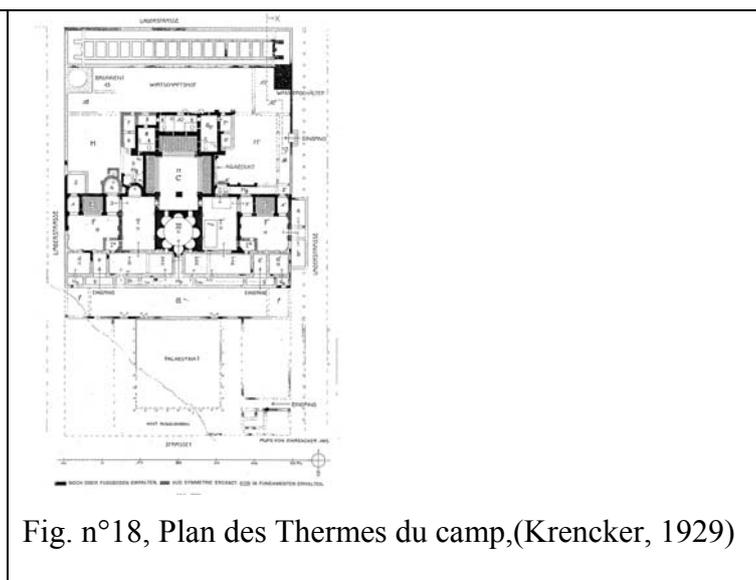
, Plan des Thermes du camp, (Krencker, 1929)
